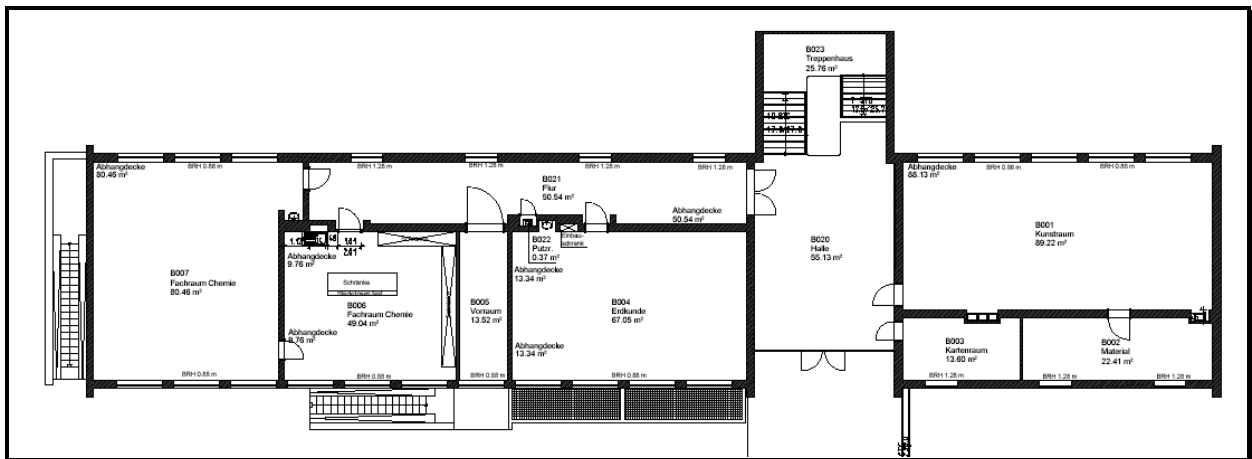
Friedrich-Ebert-Realschule: Erdgeschossgrundriss Bauteil B
